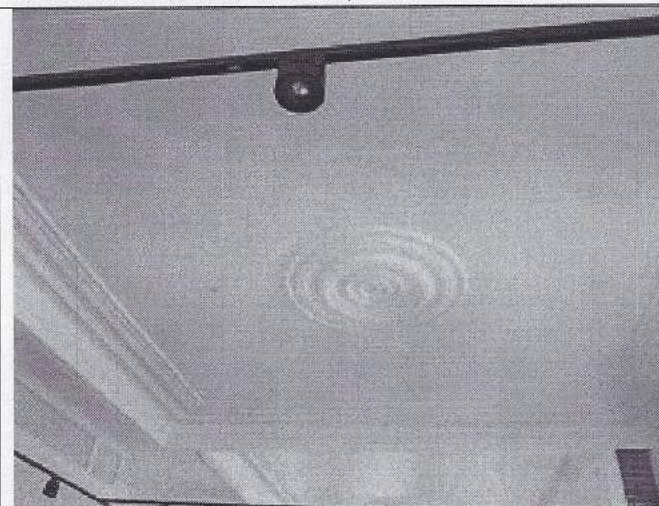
Лепные розетки и профилированные тяги на потолке в помещении 1-го этажа
